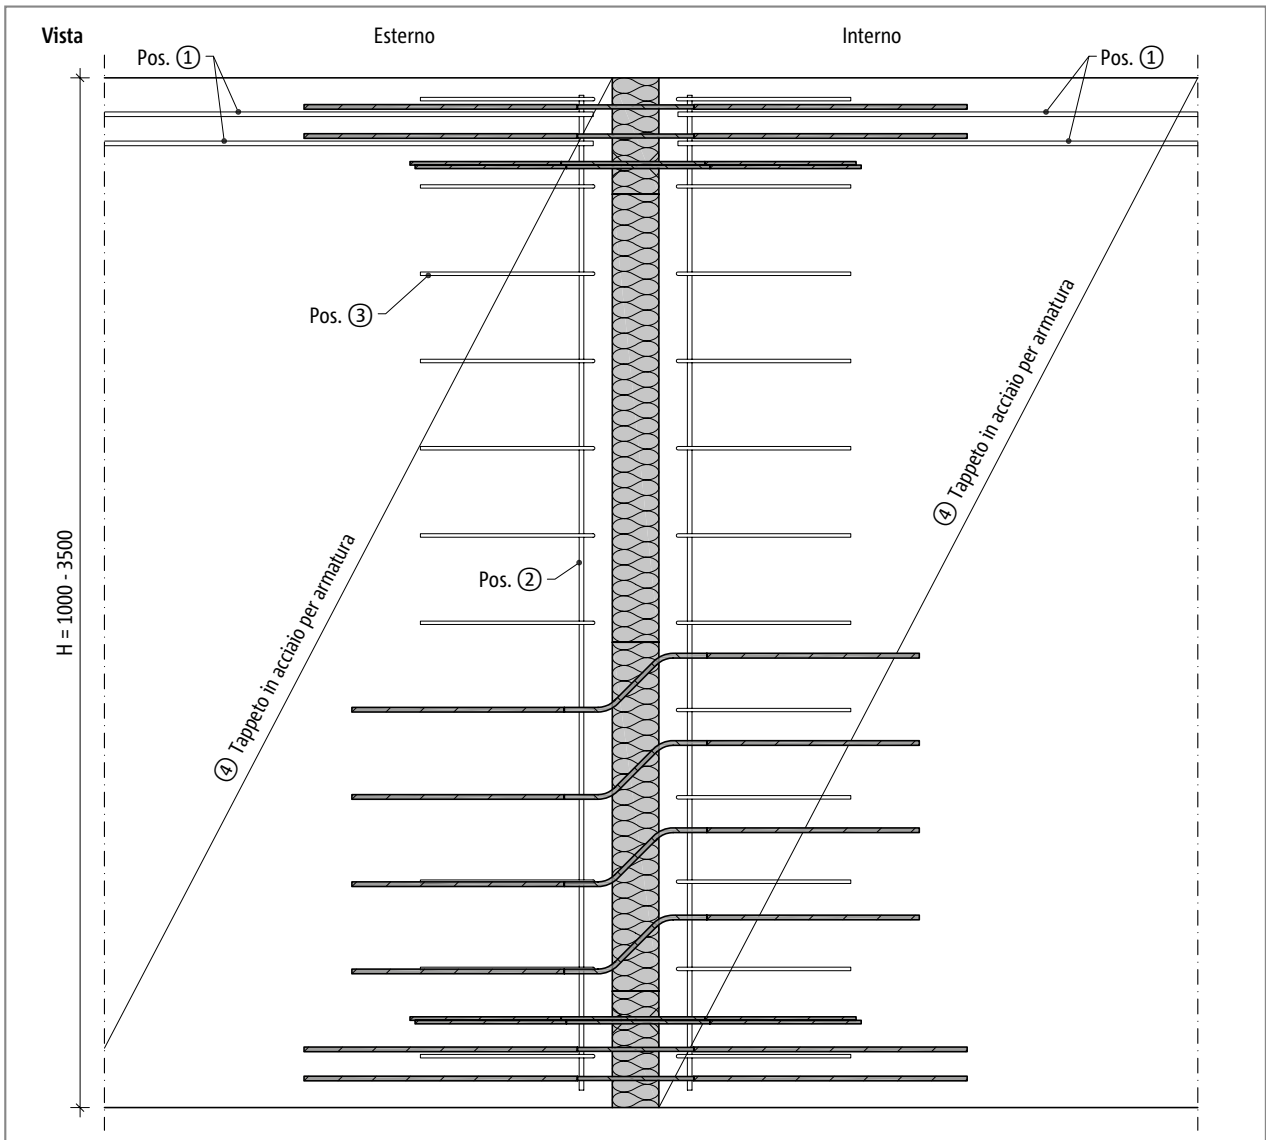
Schöck Isokorb® tipo W, sezione dell'armatura in opera
